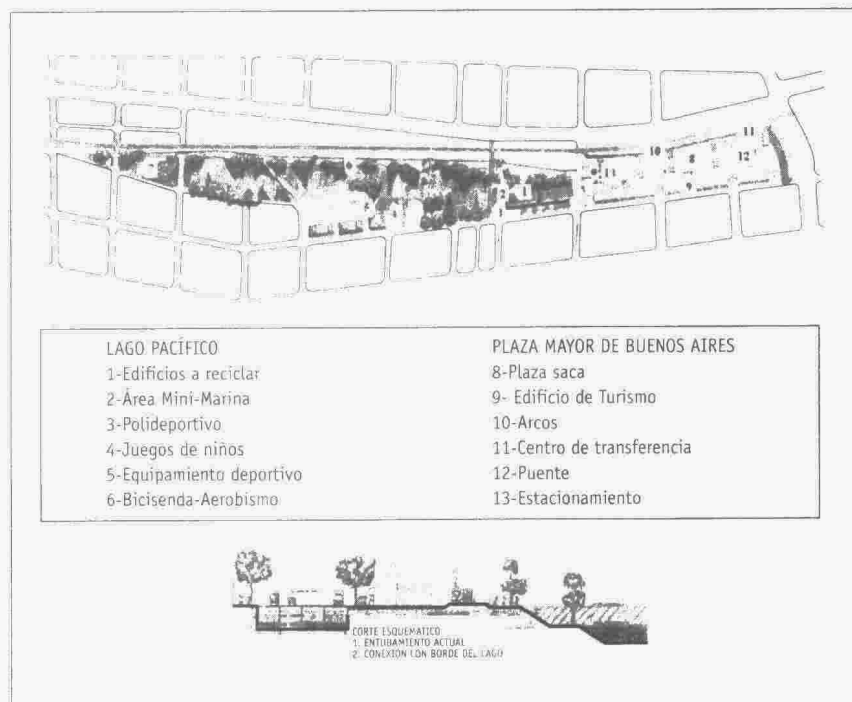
Planta de conjunto y corte transversal de la propuesta analizada
